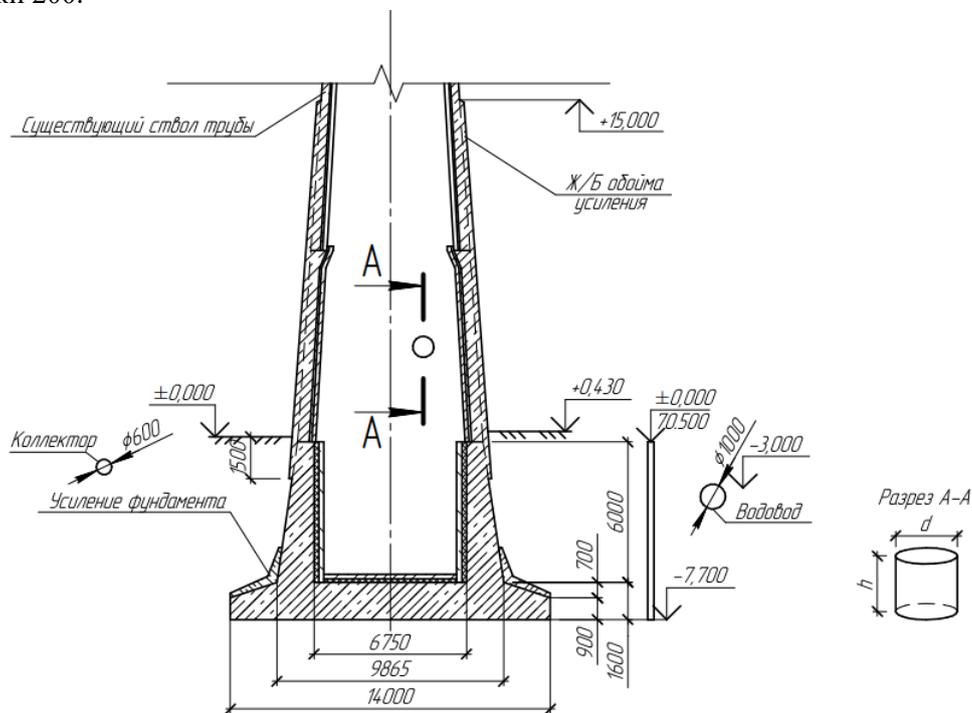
Поперечный разрез дымовой трубы коксовых батарей №5 и №6
